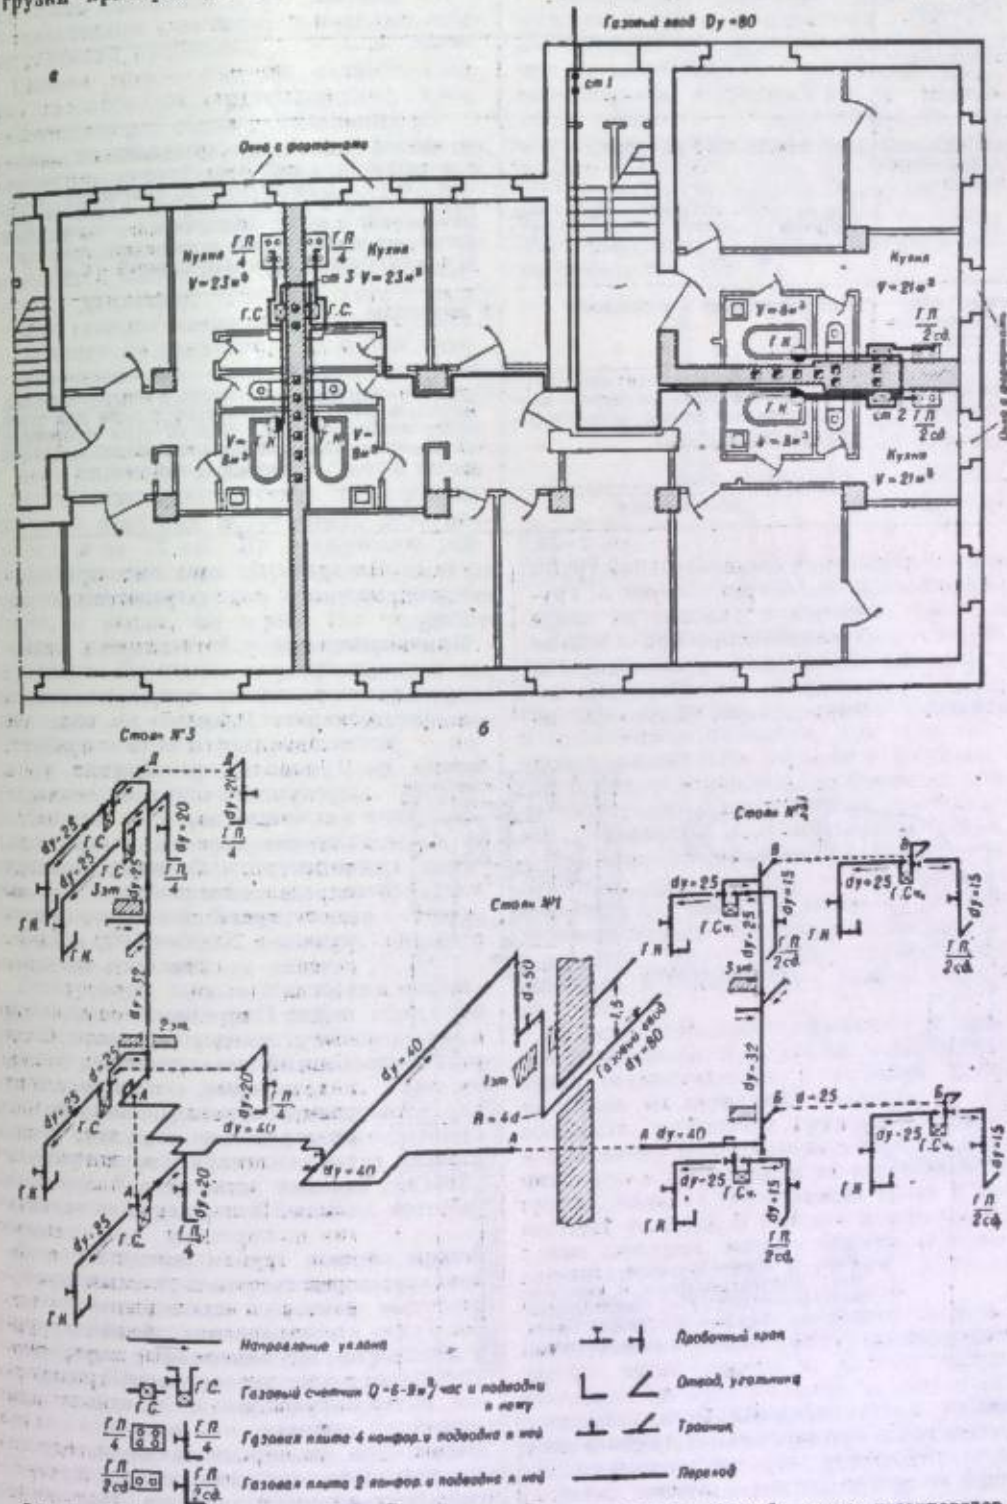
Газопроводы жилого дома: а — разводка газопроводов в плане; б — схема газопроводов.
